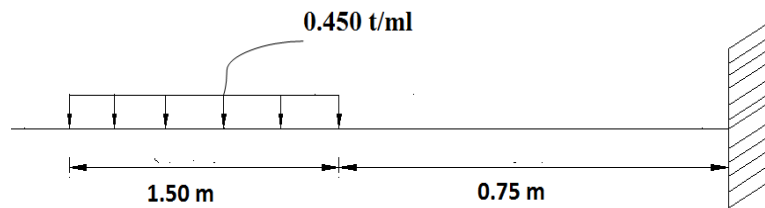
Surcharge de trottoir sur la dalle d'encorbellement
